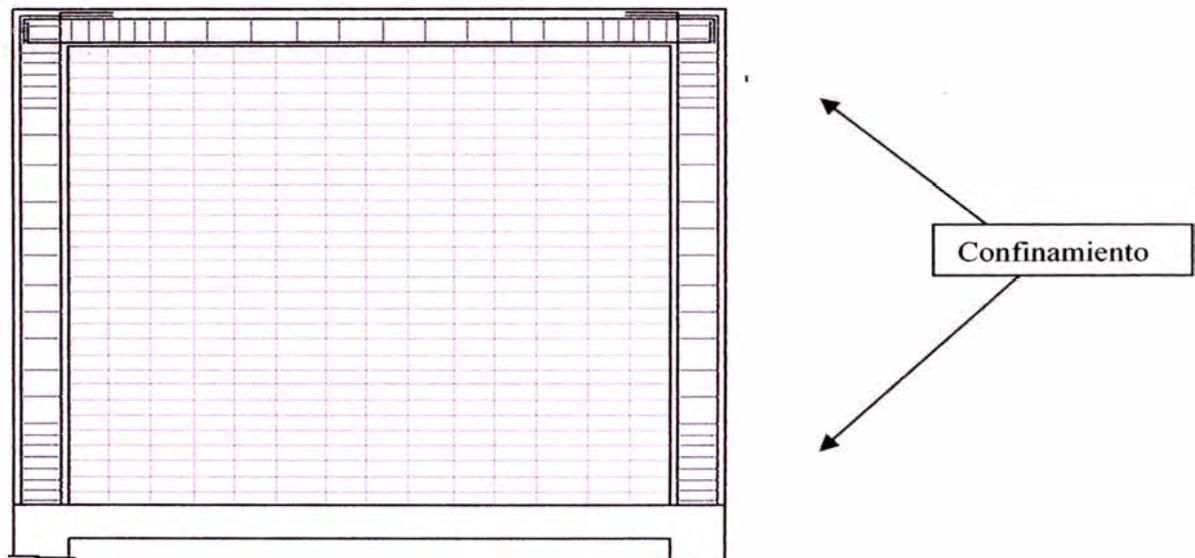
Croquis de ubicación de refuerzos típicos por confinamiento en muros de concreto armado y núcleos. Un estribo de $\varnothing 3/8''$ a 5 cm. y 4 a 0.10 m.
